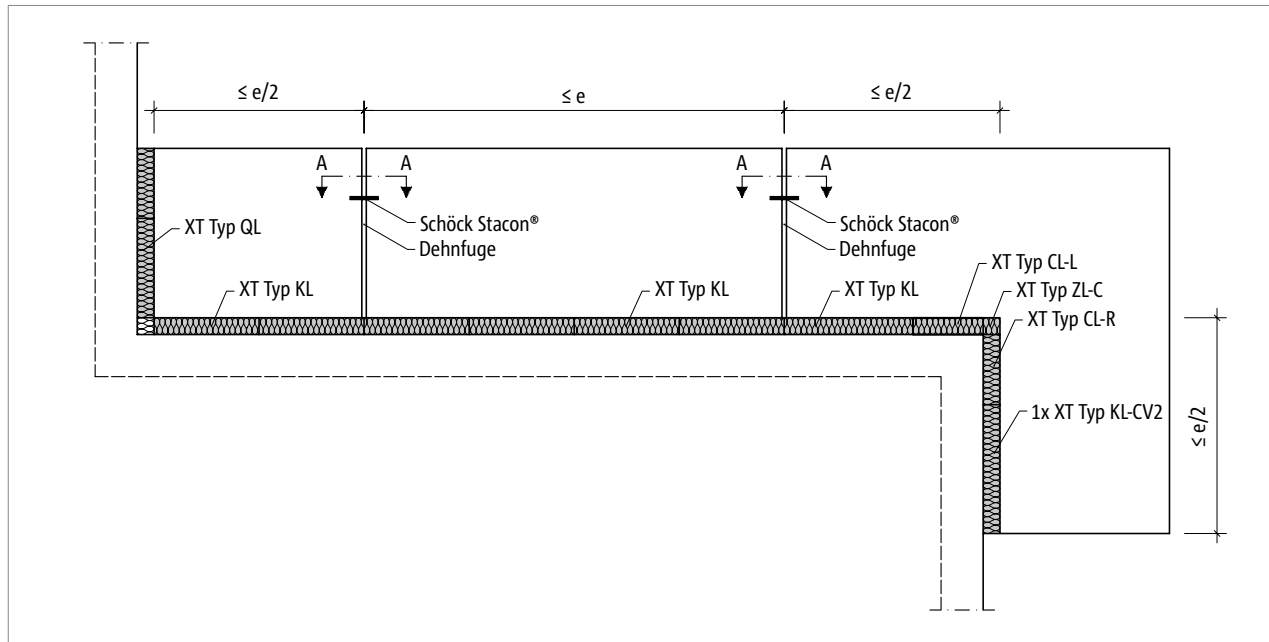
Schöck Isokorb® XT Typ KL: Dehnfugenausbildung mit längsverschieblichem Querkraftdorn, z. B. Schöck Stacon®
